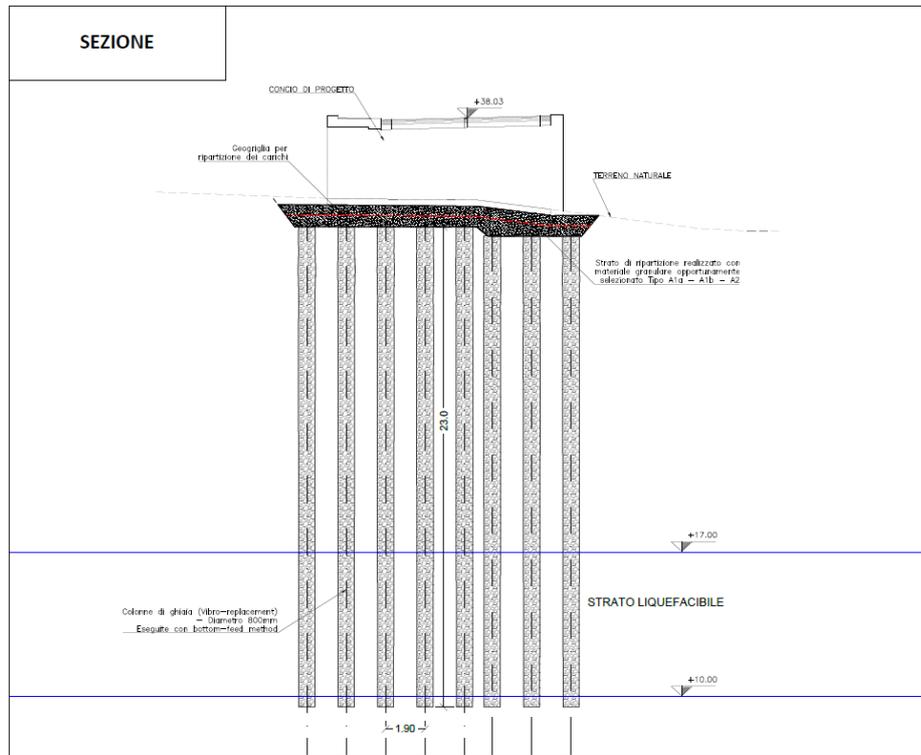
Sezione rappresentativa IV03 - rilevato 2
